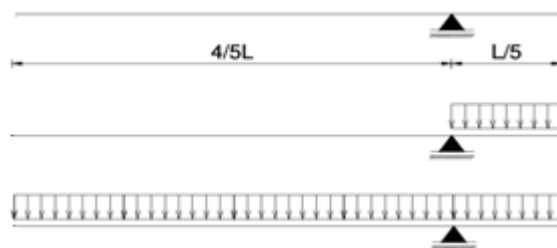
| 17 – Desenvolvimento de betonagem [51]
